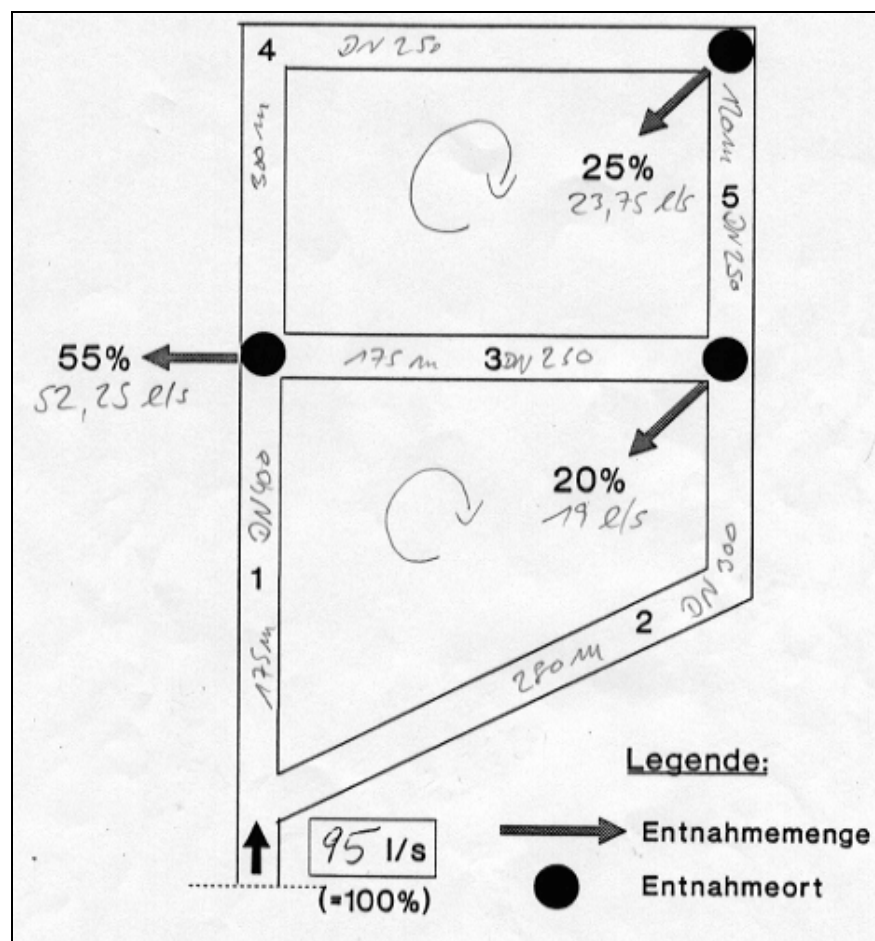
Lageplan der Ringleitung im Neubaugebiet
